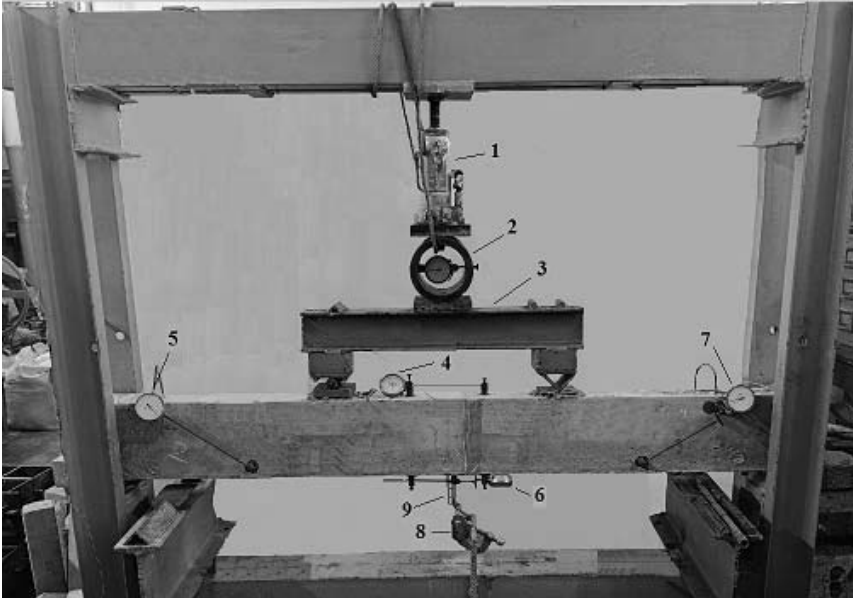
Установка для випробування однопротітних залізобетонних балок.
